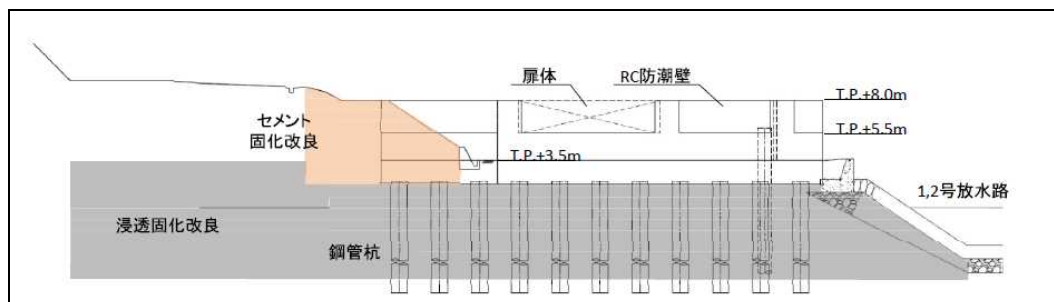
防潮扉横断面図 (関西電力 高浜 1, 2 号炉)
